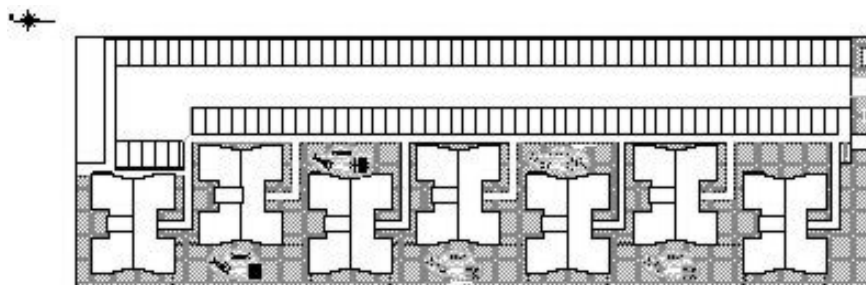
Implantação – Empreendimento OR (semelhante ao RD)
